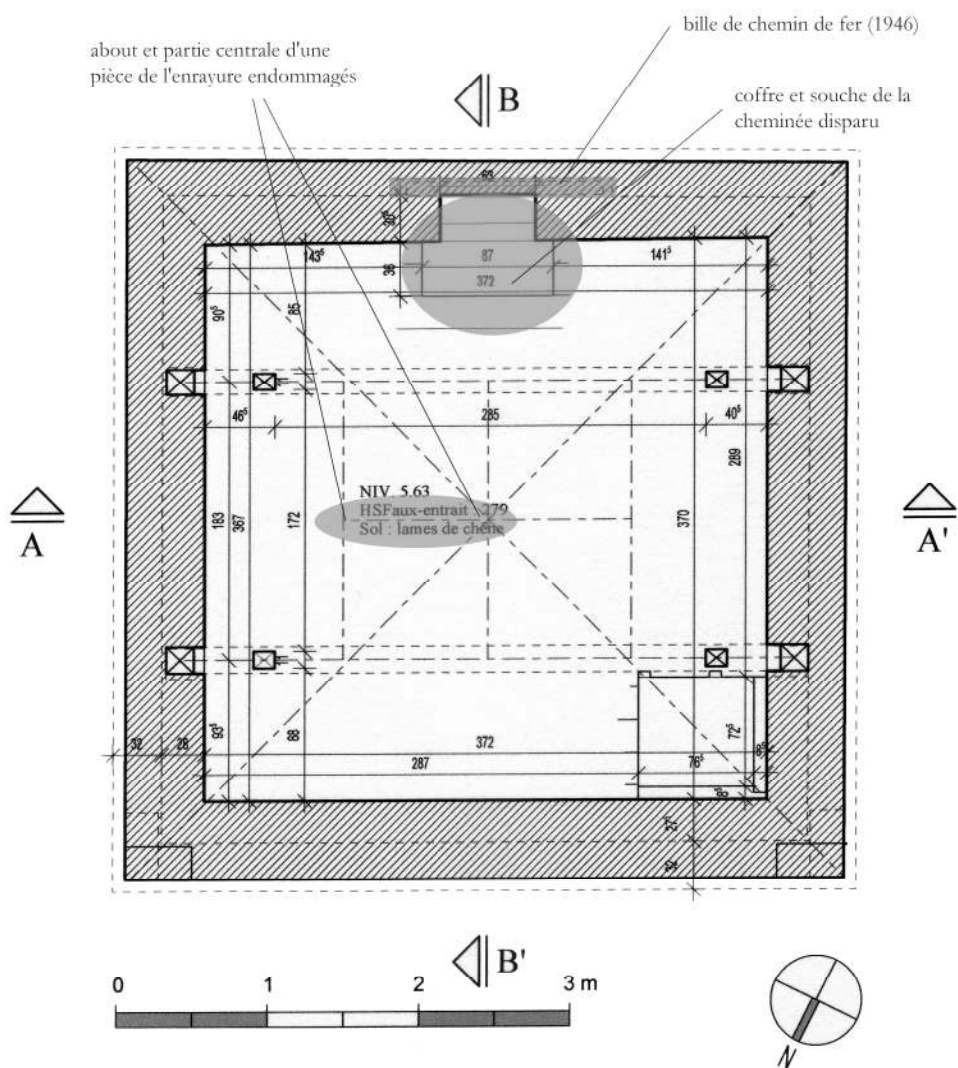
Pavillon. Vue en plan du comble. Ech. 1/50^e. Etat sanitaire. IG 2008.
